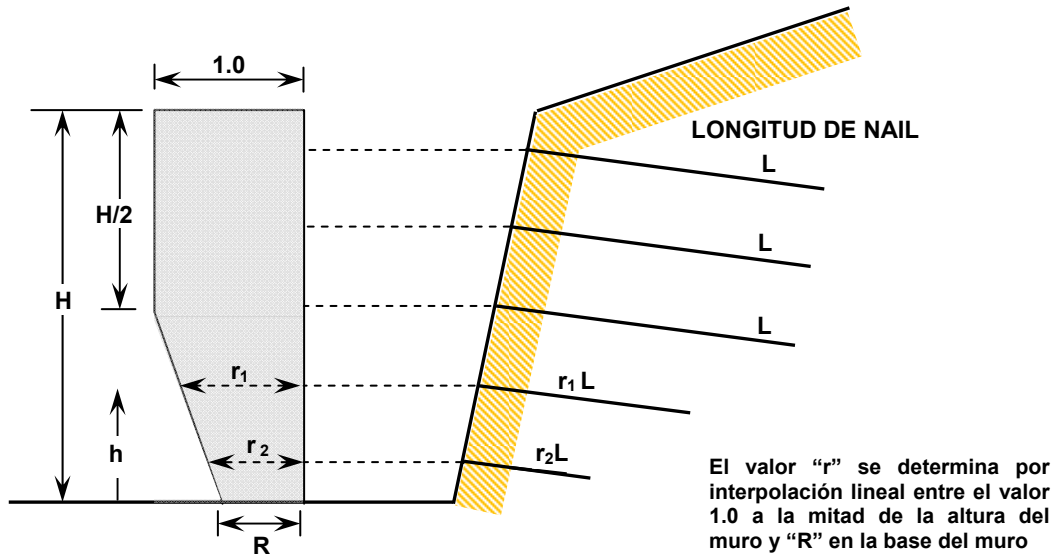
Variación de la longitud de los Nails según la elevación dentro del muro.
